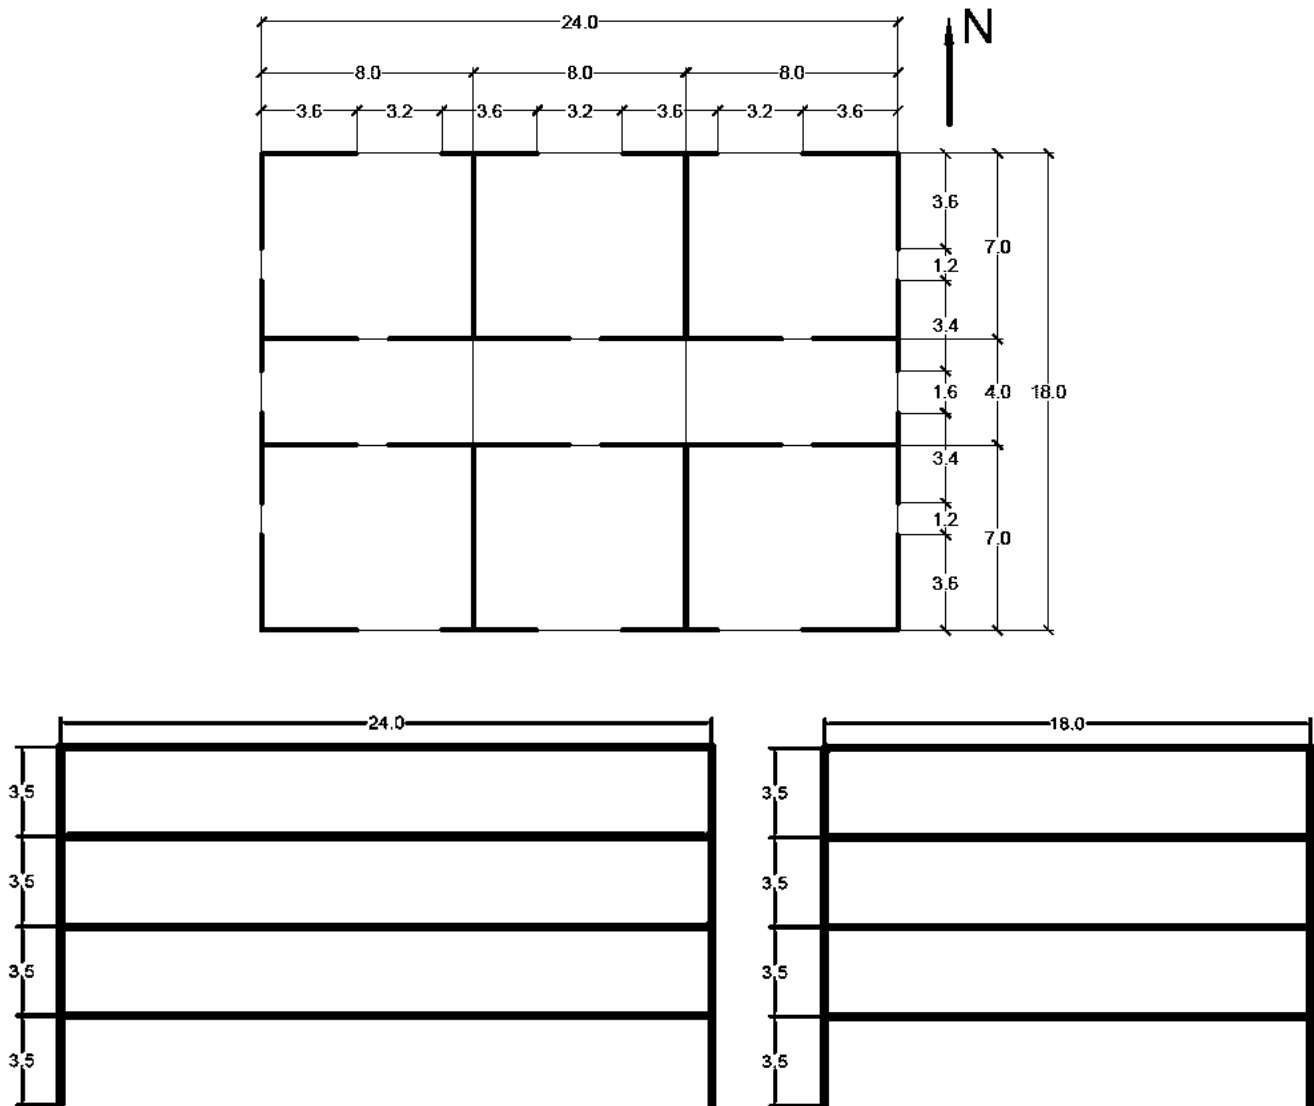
Dimensiones en planta y elevación de la edificación N4D1
